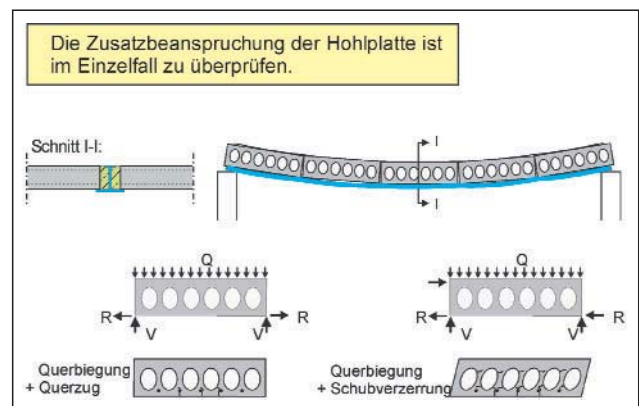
Spannbeton-Hohlplatten bei Auflagerung auf deckengleichen Stahlträgern (Slim floor)
